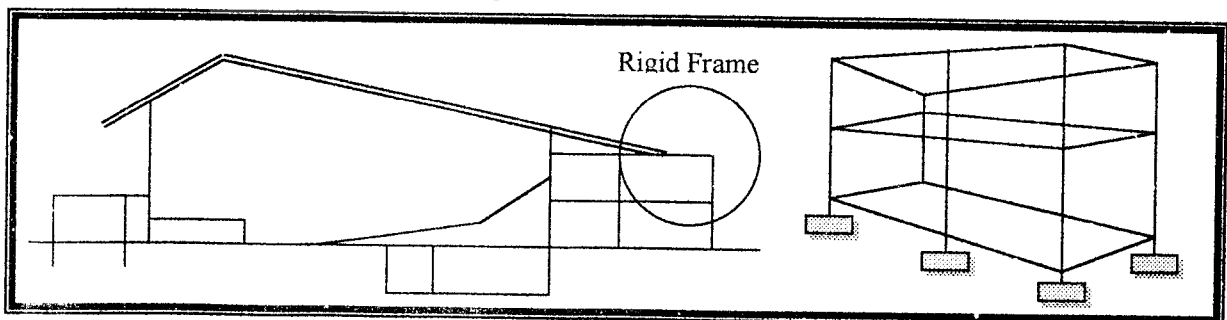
11. Konsep Struktural Ruang Pagelaran Wayang
